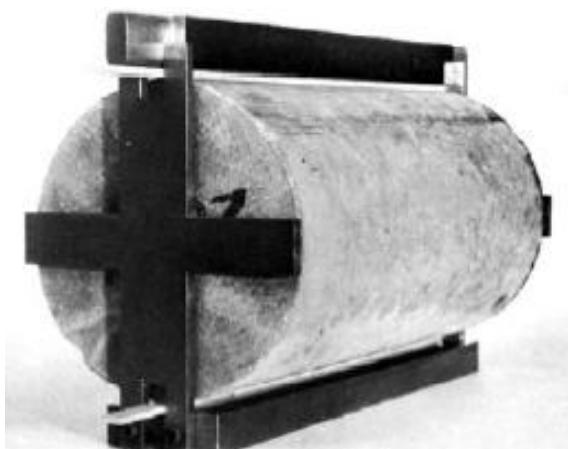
3. Plantilla para alinear el cilindro de concreto y los listones de apoyo
